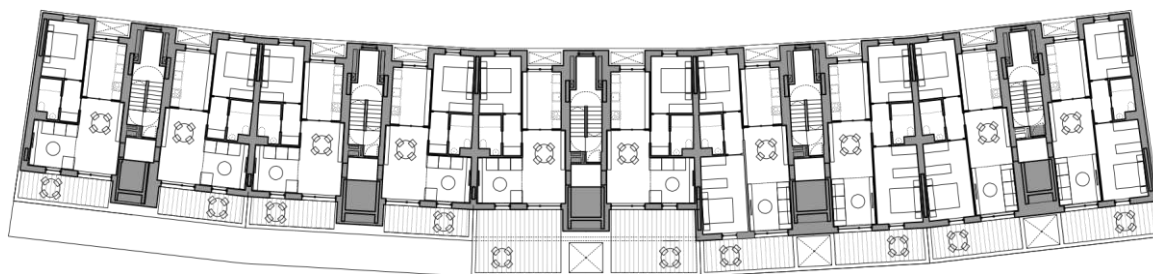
Planta tercera de viviendas. Fuente: Elaboración propia.
